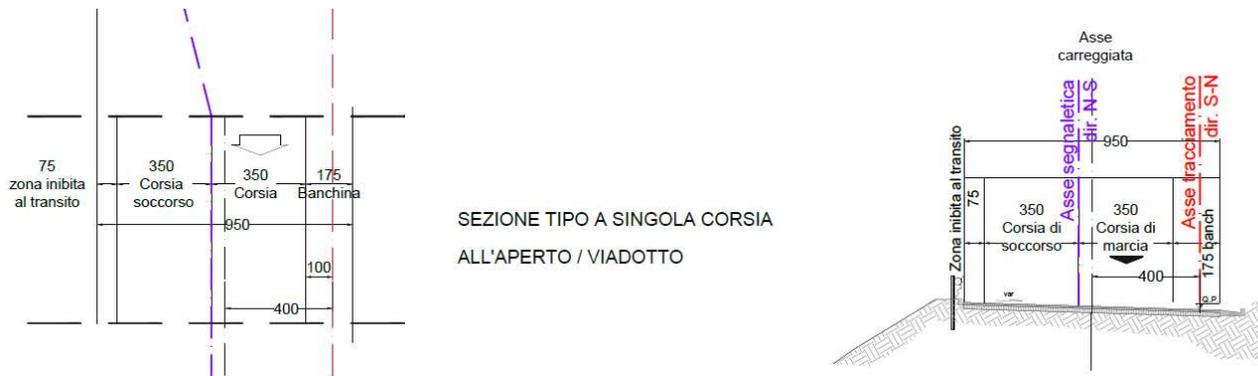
Schema planimetrico e sezione stradale per i tratti all'aperto a singola corsia
